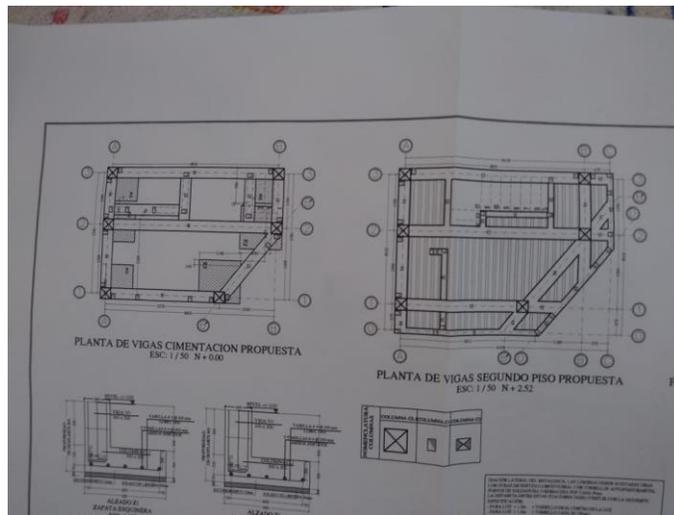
Lugar donde debería ir la columna no construida.
